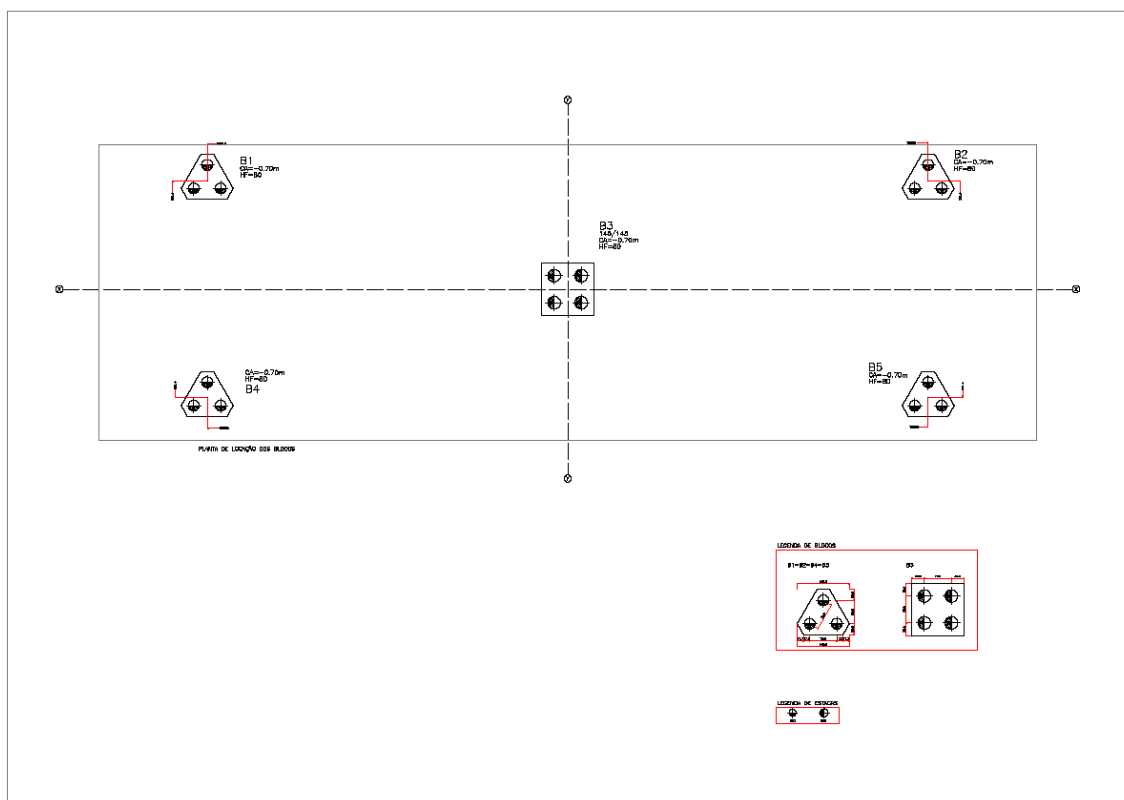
Fundação: planta de localização dos blocos. Fonte: AUTOR (2017).
